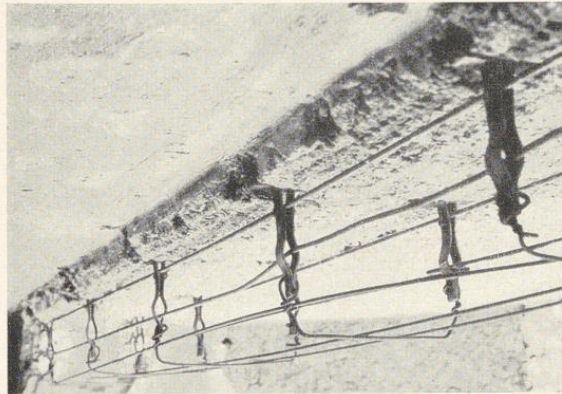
Abhängung der Rabitzkonstruktion an eiserner Trägerdecke mit angeschraubten eisernen Schellen
